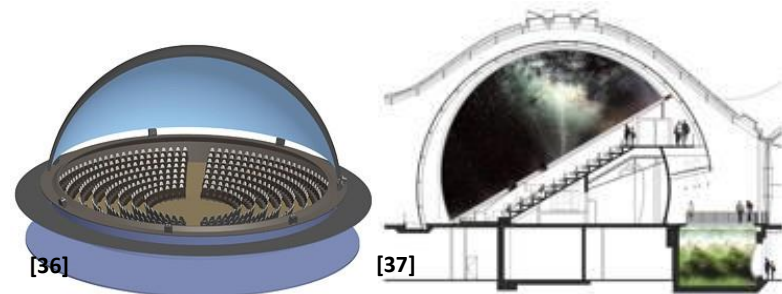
Cúpula en plano horizontal. Imagen 37 Cúpula inclinada.
